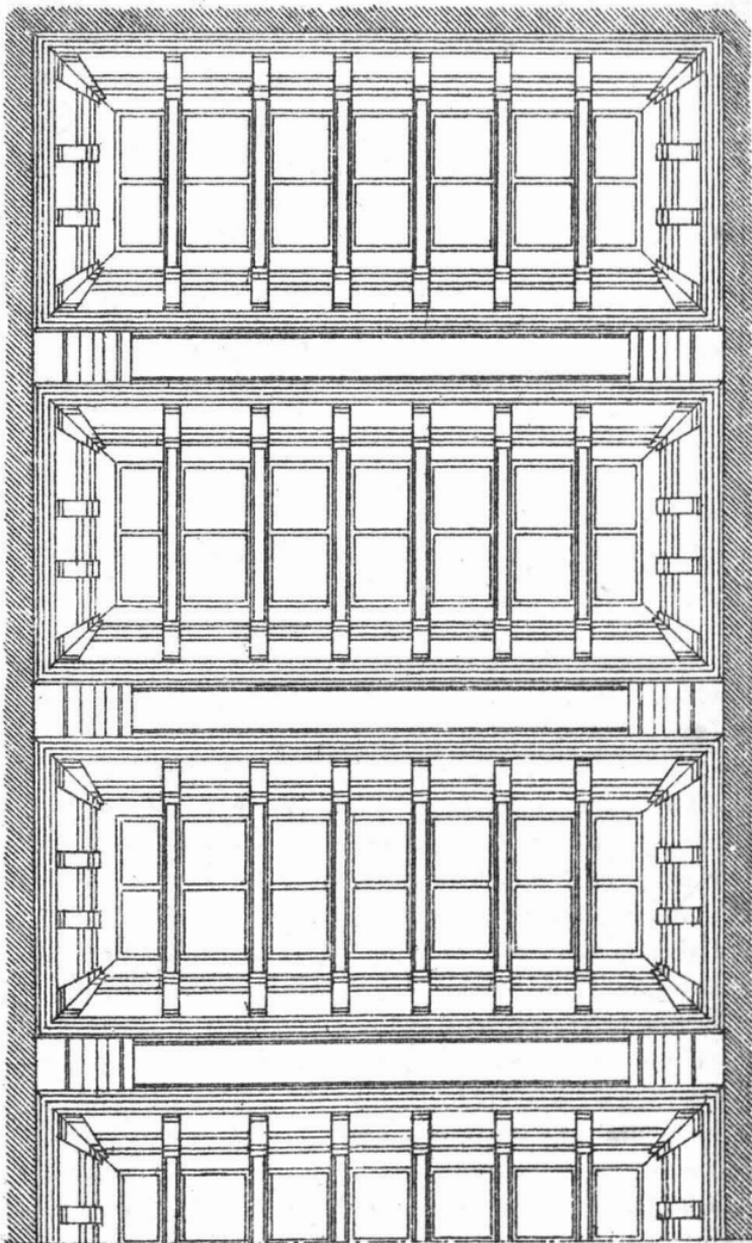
Metà pianta di un soffitto (1 a 50).
